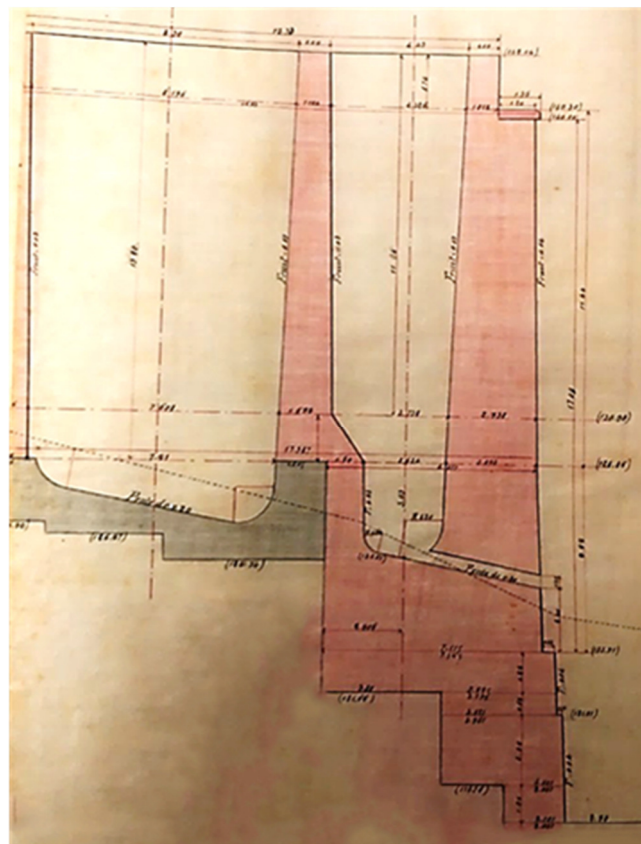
Pormenor da secção vazada dos encontros e a sua drenagem [4]
